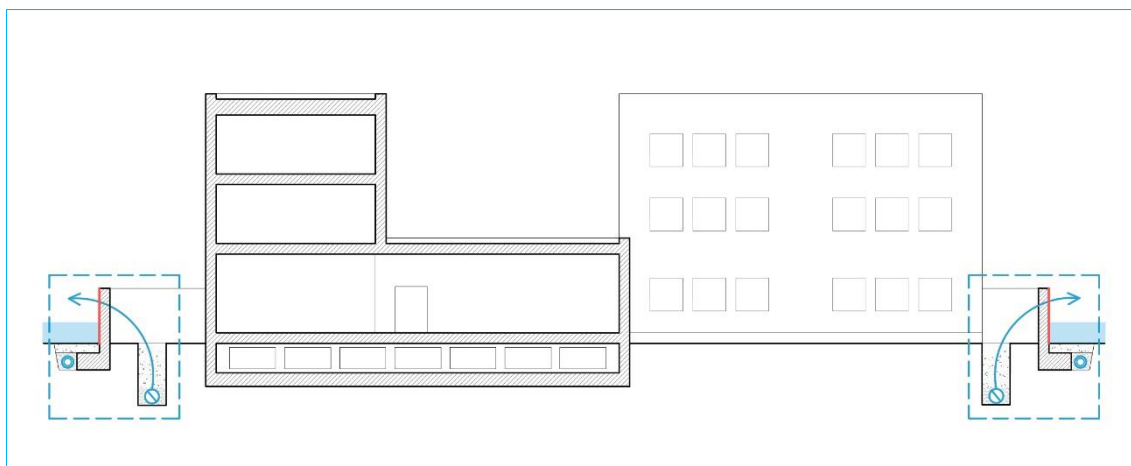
Medidas de tipo EVITAR. Esquema en sección: barrera perimetral y zanja filtrante.
